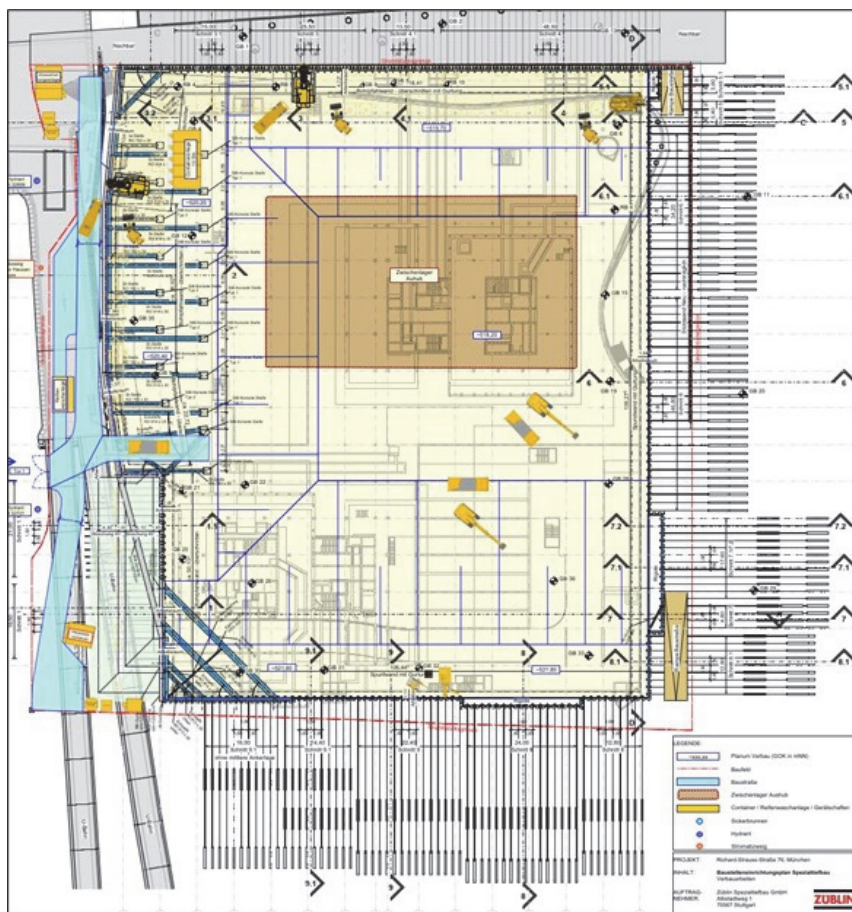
Ausschnitt aus BE-Plan, Grundriss (eigene Skizze ZÜBLIN, 2021)
